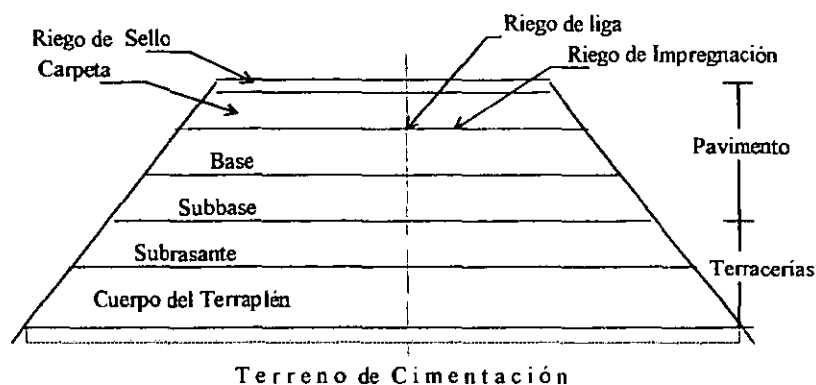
ESTRUCTURA DE UN PAVIEMTO ASFÁLTICO (FLEXIBLE)
